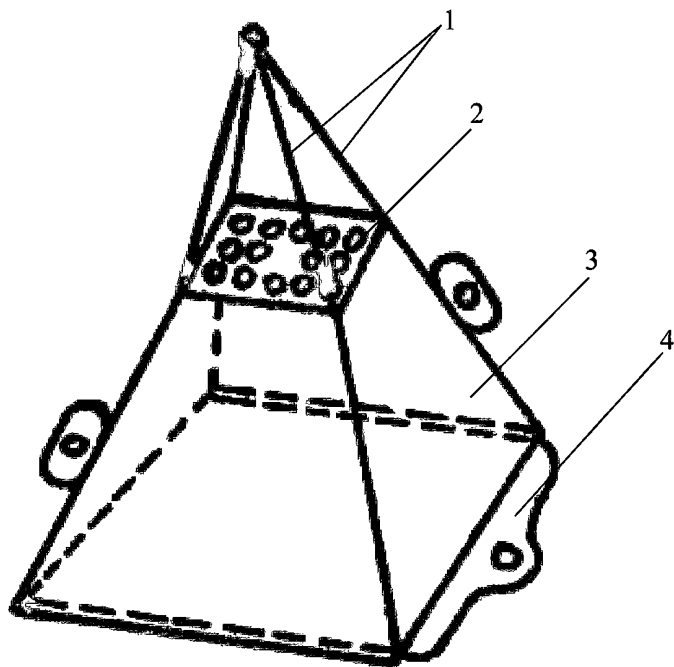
Схема конструкции бады для подачи мокрой бетонной смеси:
